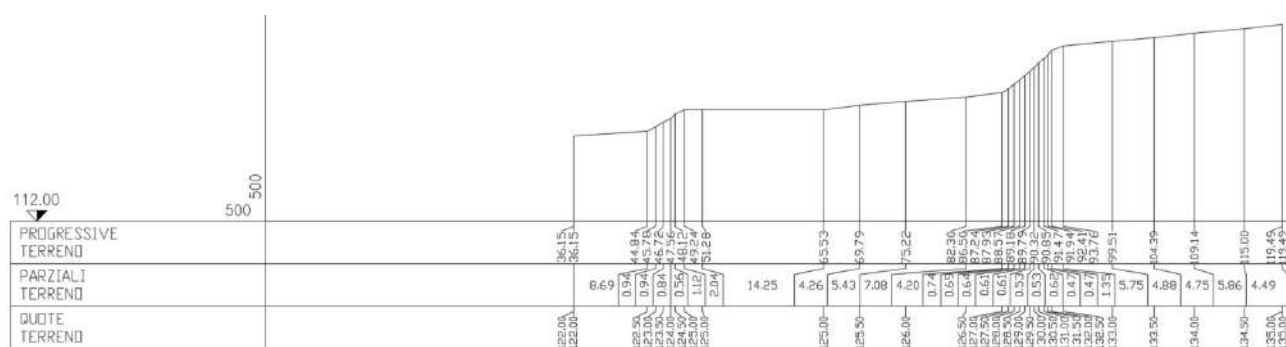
Profilo attuale in corrispondenza della sezione 4
